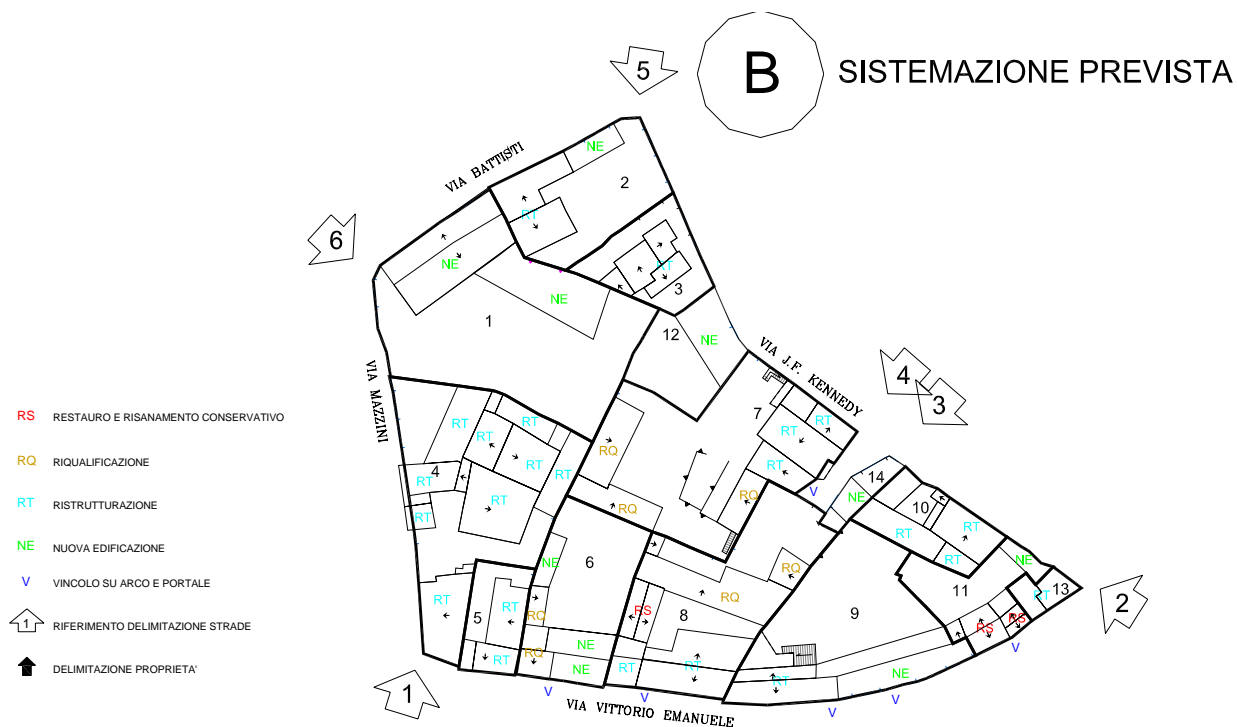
Planimetria riepilogativa degli interventi previsti nell'isolato B.
